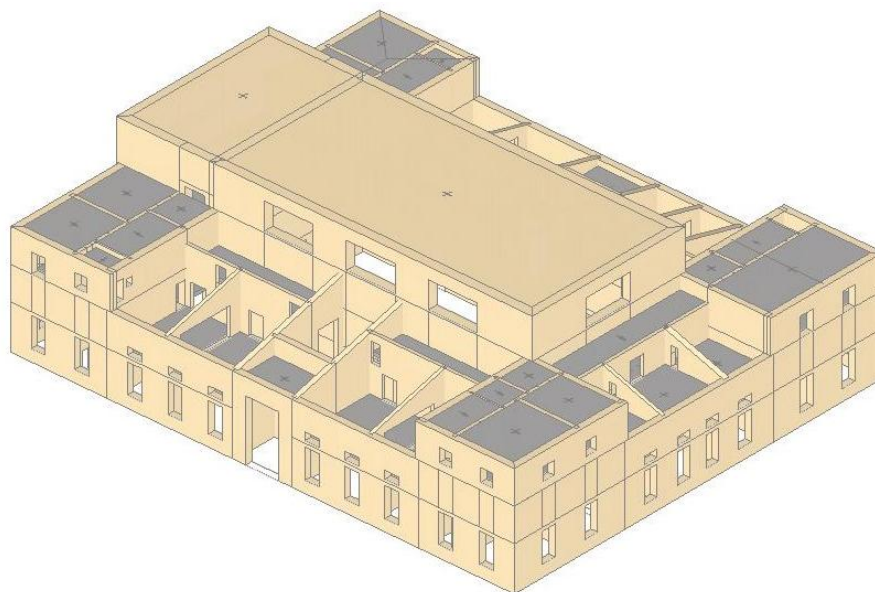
Vista tridimensionale - Prospetto est su via Coccapani e Prospetto sud lato Cortile
